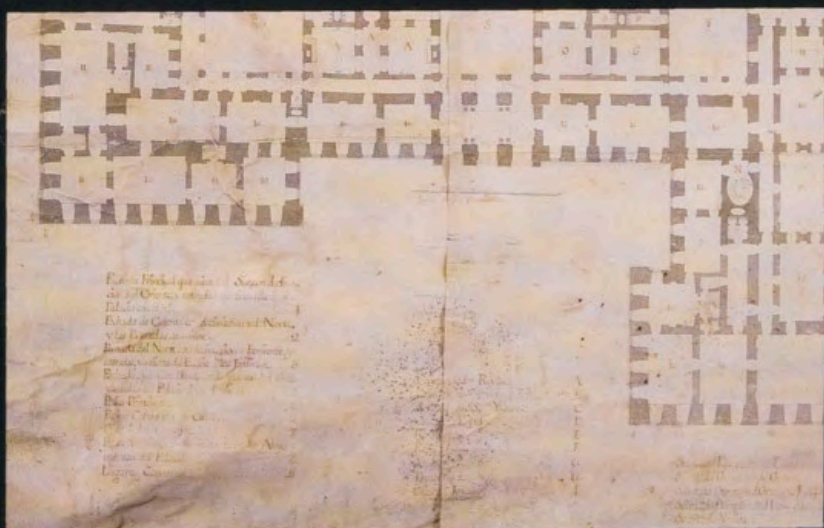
, Filippo Juvarra, Proyecto para el Palacio Real de Madrid, Detalle de la leyenda de la planta del piso bajo, AGP, Planos, 6.500, Madrid, Patrimonio Nacional.
